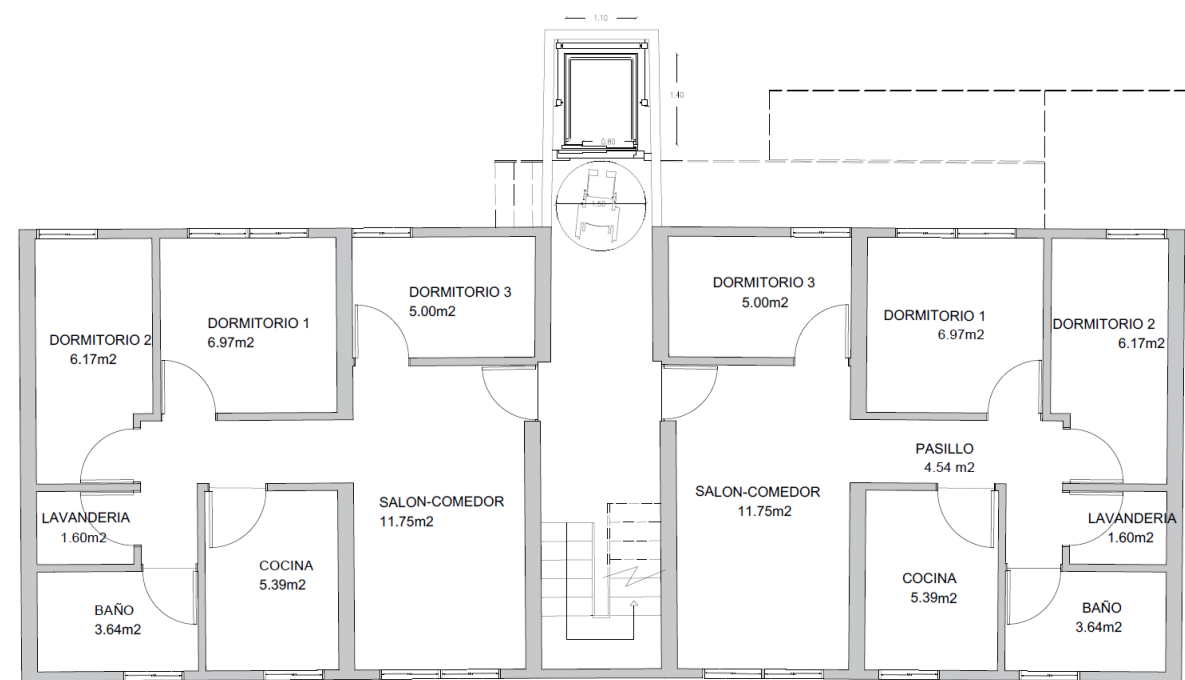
Nueva distribución P1→ P4 con ascensor ya instalado.
